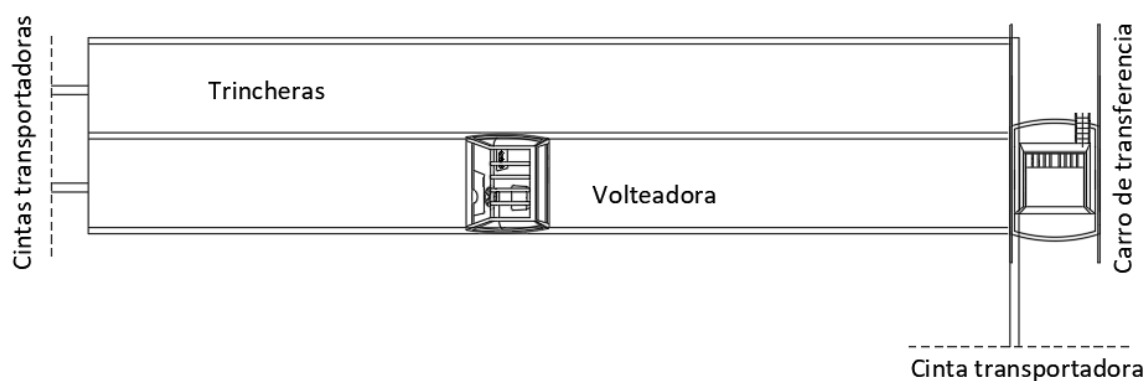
Vista en planta del área de maduración. Fuente: Elaboración propia
